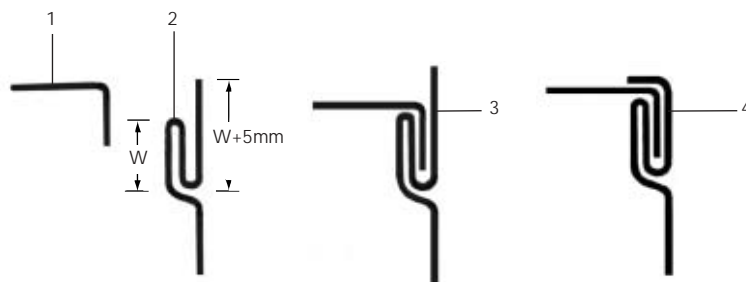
Detalhe construtivo da união / junta Pittsburgh.
